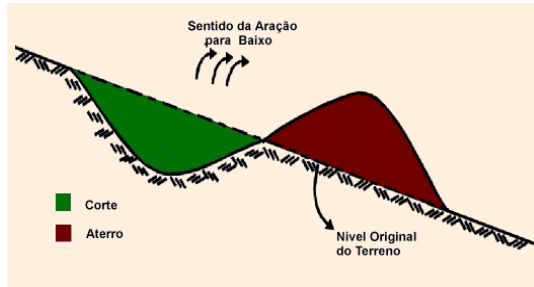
Perfil esquemático de um terraço tipo Nichols.
